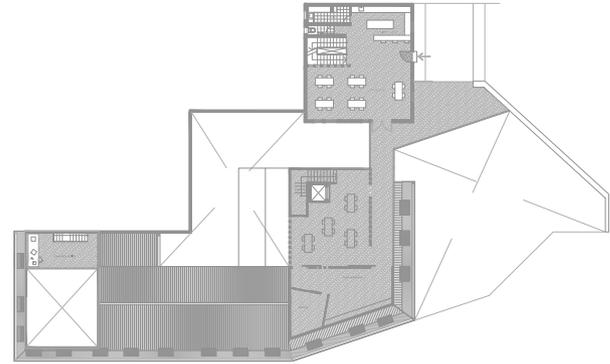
Planta 4to nivel, Centro Extensión GAL_212
